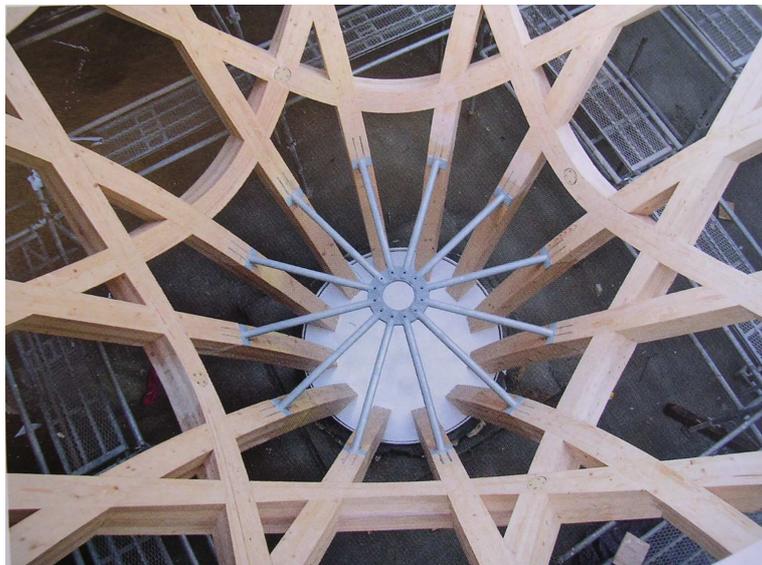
Anschluss der Dachelemente an den Stahlring
